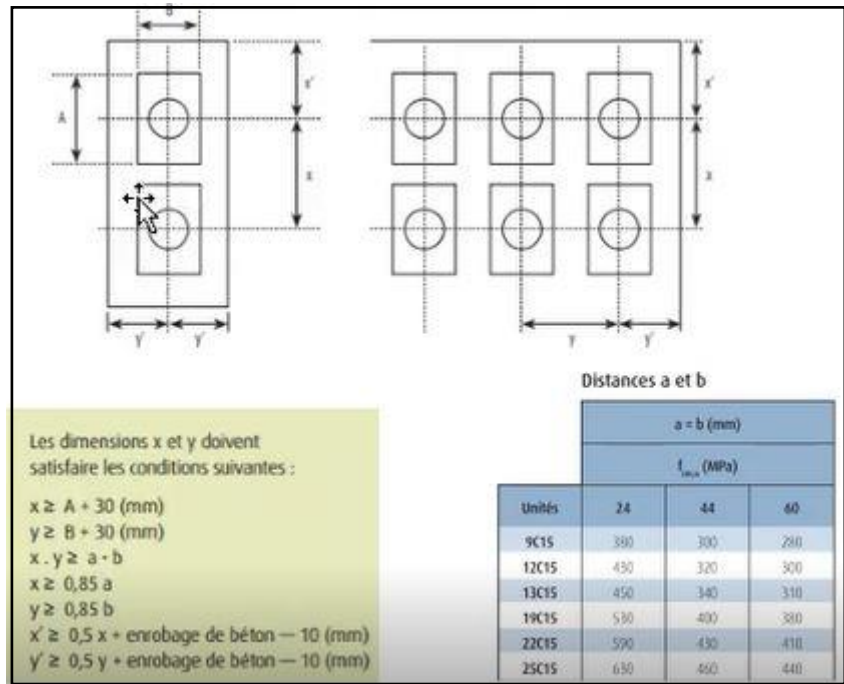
condition de disposition des plaques d'ancrage
